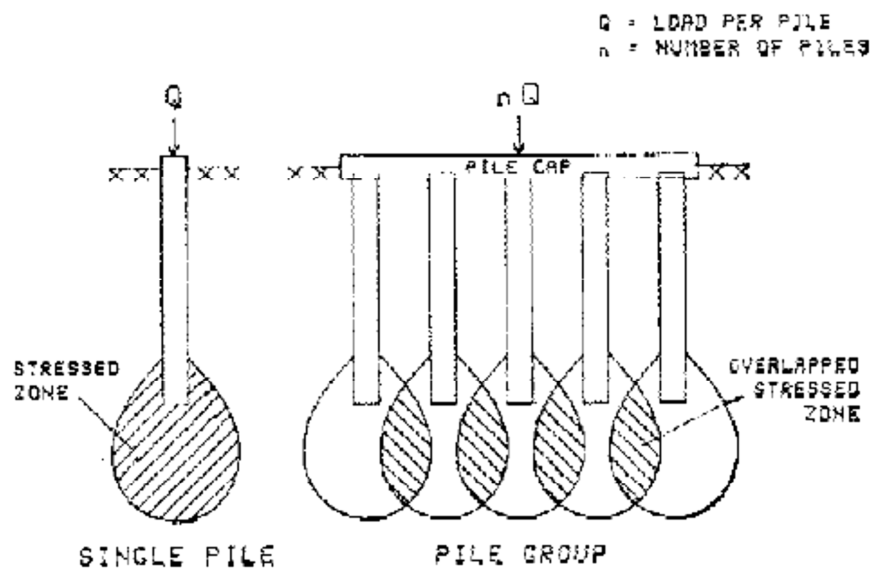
Zonas de esfuerzos en suelos soportando un grupo de pilas (U.S. Army Coop of engineers, 1992,p.5-43)
